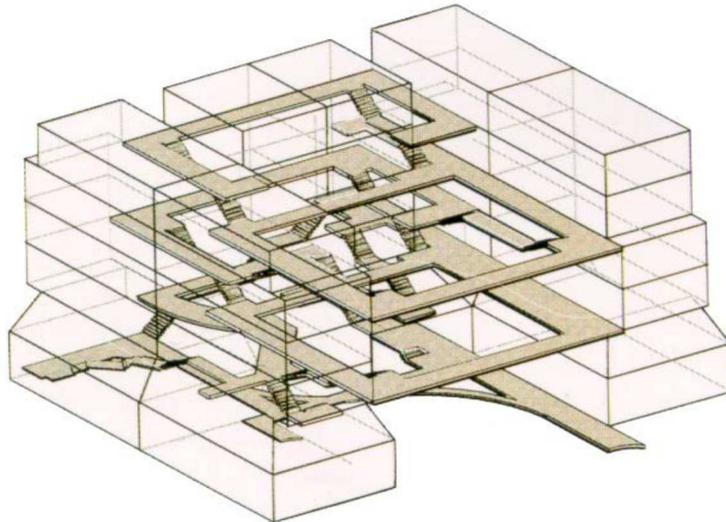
Esquema de la zona de calle; Fuente: [www.openbuilding.org](http://www.openbuilding.org)
